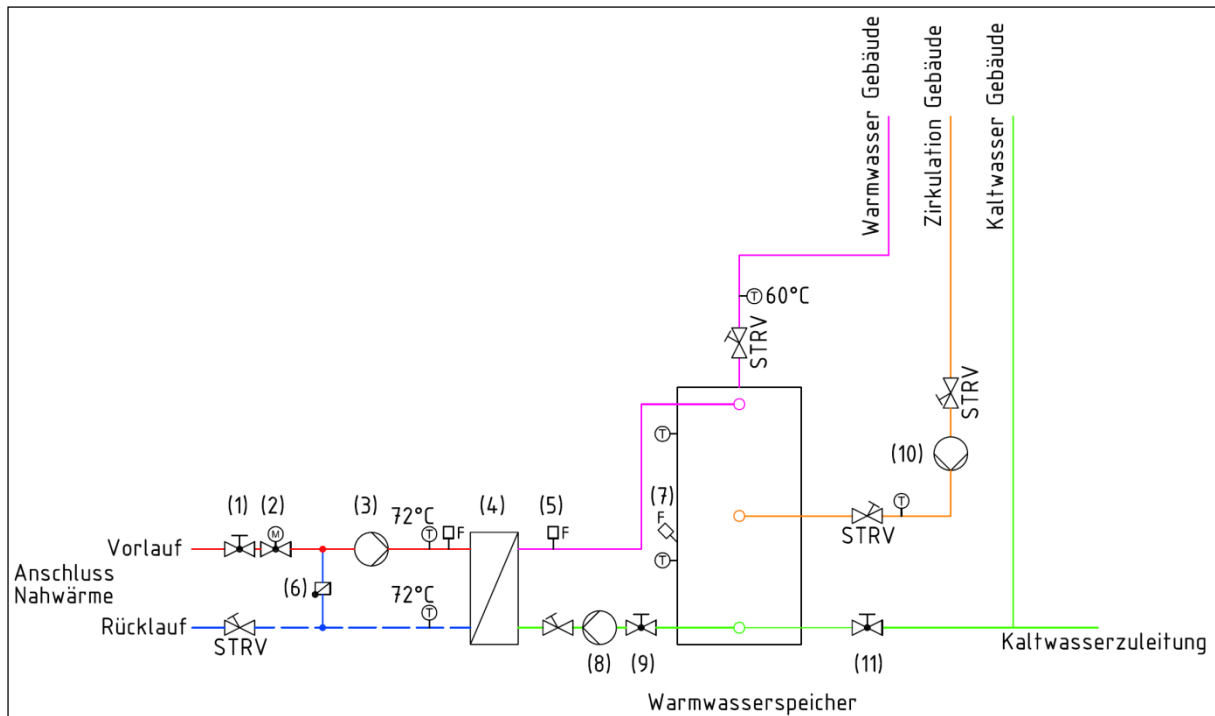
Brauchwasserbereitung mit Speicherladesystem
